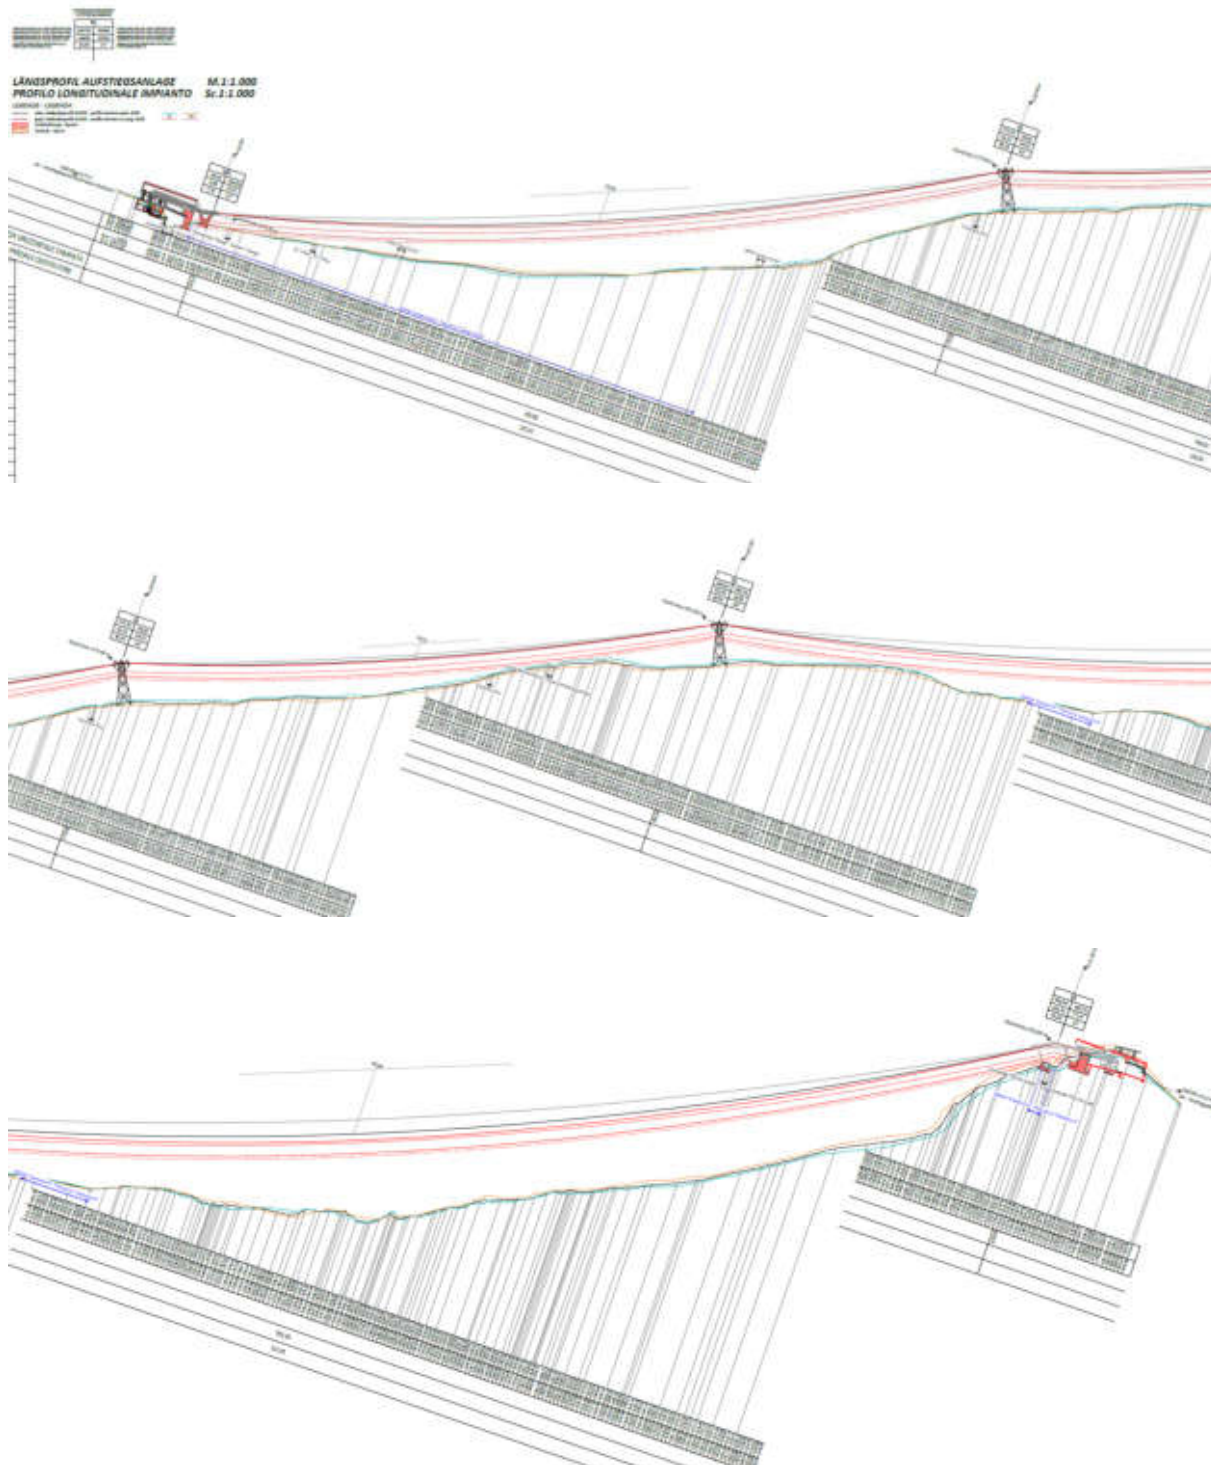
Auszug aus dem Projekt – Längsschnitt Trasse / stralcio da progetto – sezione longitudinale tracciato
